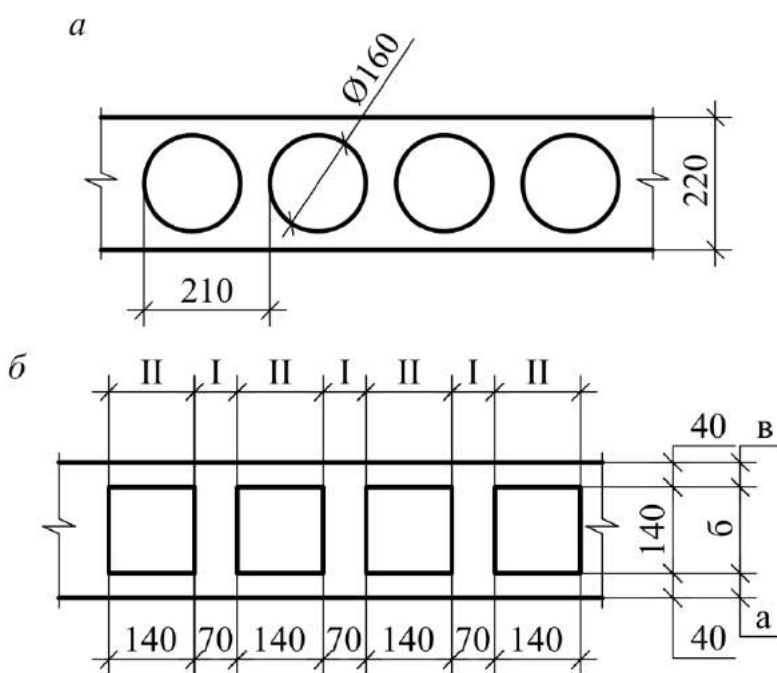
Поперечное сечение плиты (а) и расчетная схема (б)
